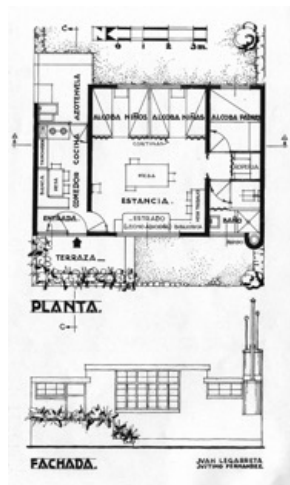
PLANTA Y FACHADA DEL PRIMER LUGAR DE CONCURSO.
